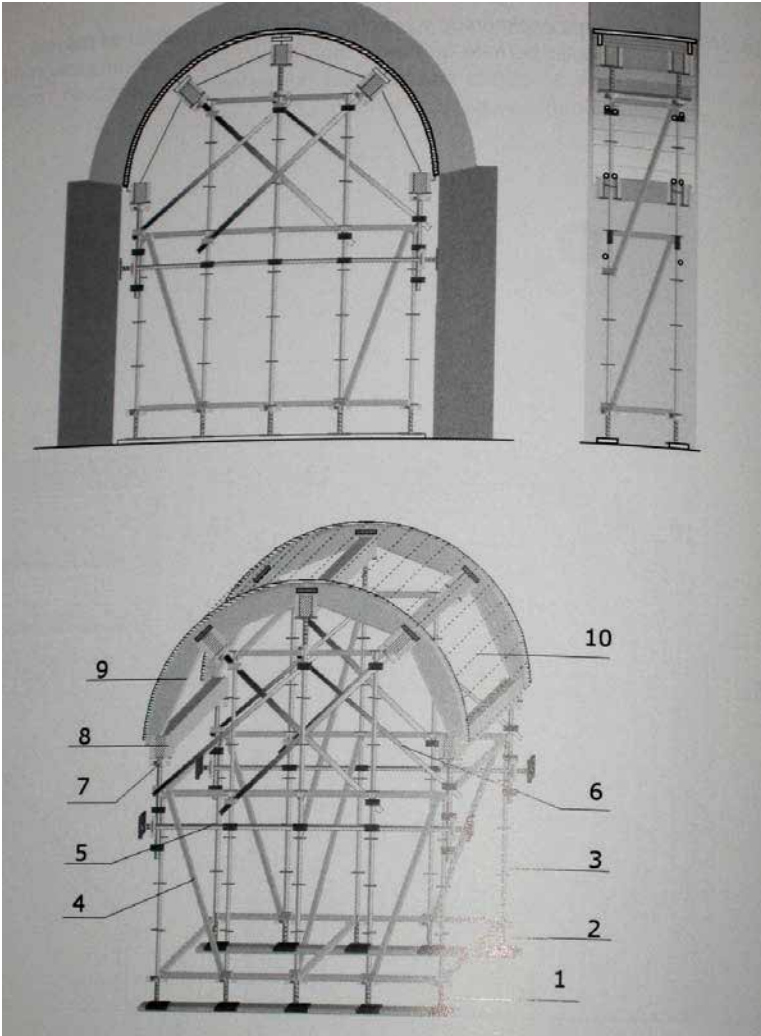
Apeo o encimbrado con madera, tubos, bridas y estructura modular.
